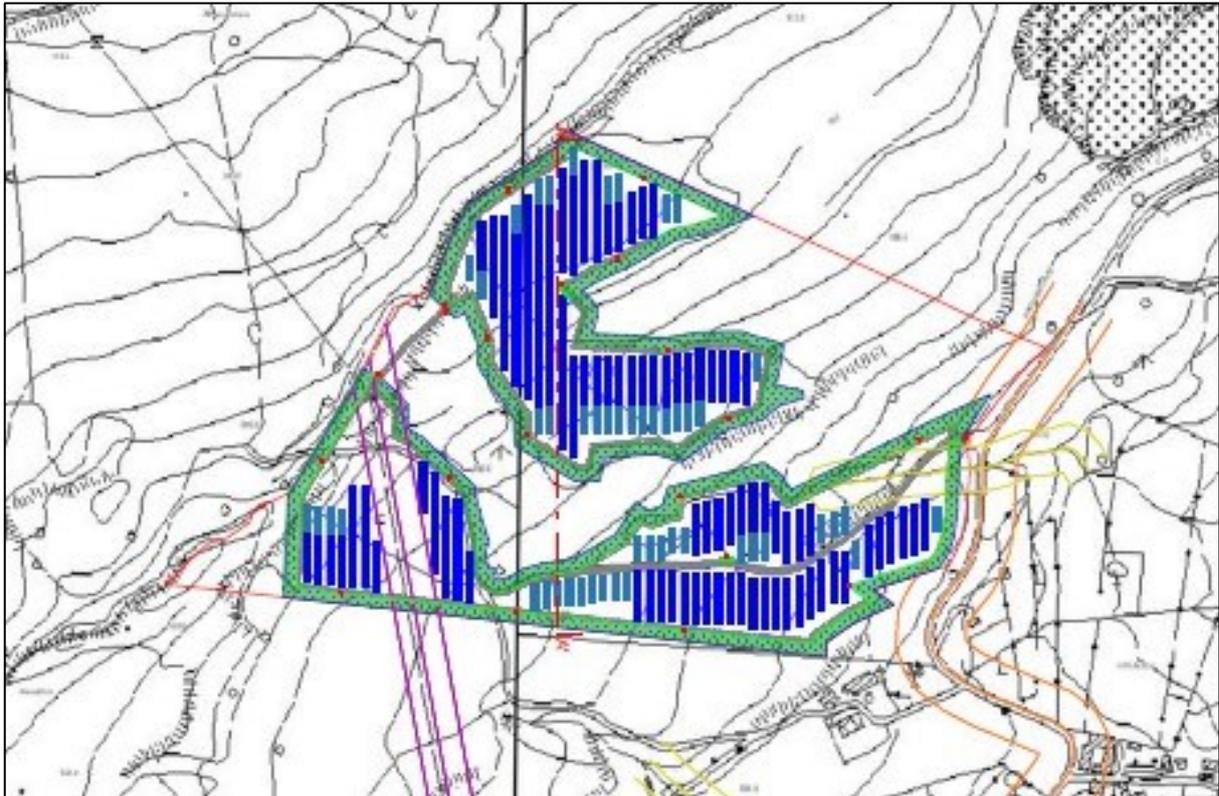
Planimetria e indicazioni delle sezioni – sottocampo 1
